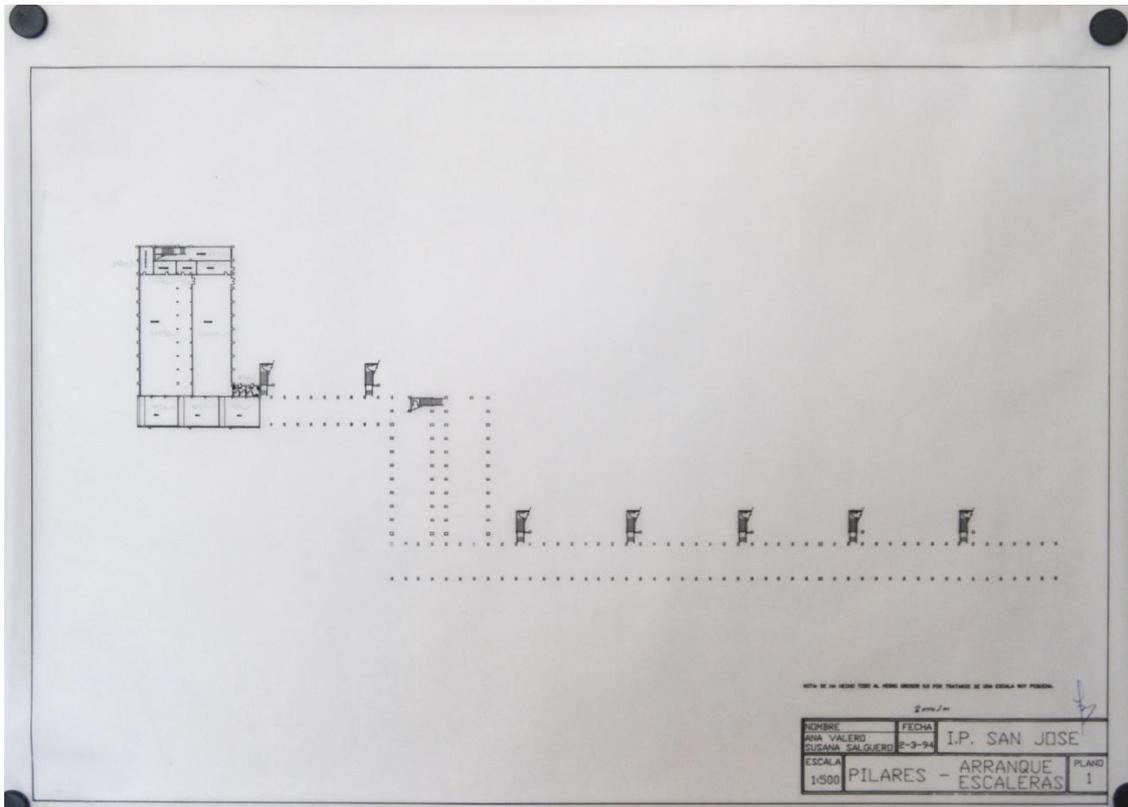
Plano de pilares pabellón aulas. *Archivo Escuelas San José.
